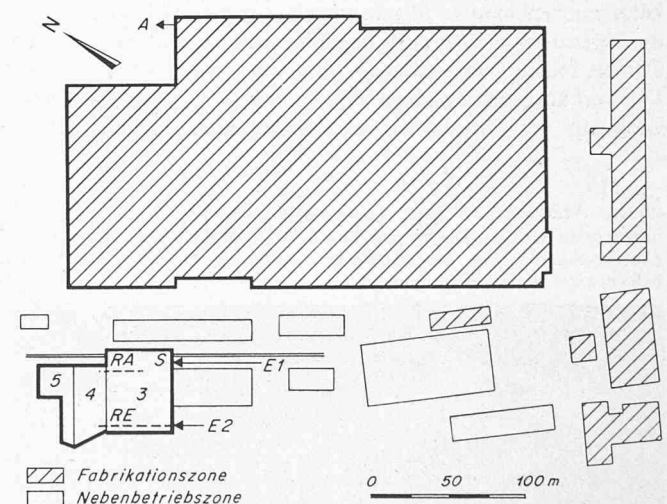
Lageplan. Das bestehende herkömmliche Fertigmaschinenlager befindet sich am Standort 3, das neue Hochregallager für Webmaschinen bei 4 und das daran anschliessende Palettenhochregallager bei 5. Die Spedition hat ihren Platz bei «S» innerhalb des Gebäudes 3 und ist mit Gleisanschluss versehen. Der Ausgang der fertig montierten Webmaschinen befindet sich in der Fabrikationszone bei A. Der Eingang in das bestehende Fertigmaschinenlager war bei E1. Der neue Eingang in das bestehende Lager und das neue Hochregallager für Webmaschinen befindet sich bei E2.
